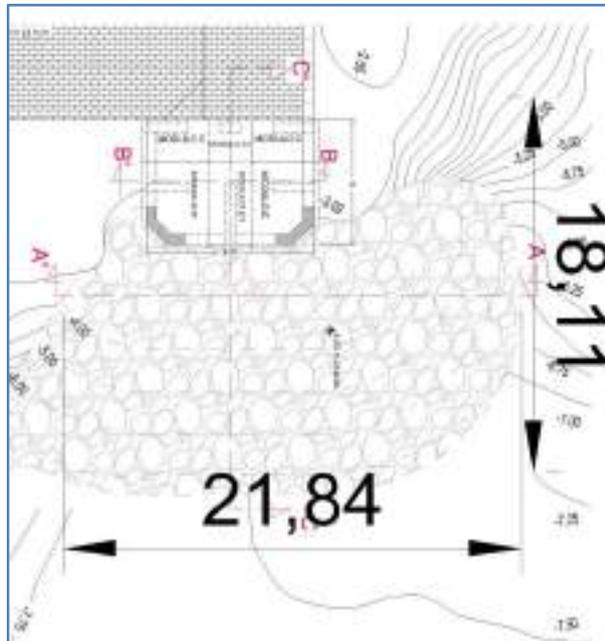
Superficie di fondazione composta dall'area del preesistente rilevato di scogliera e dell'allungamento previsto in progetto.
